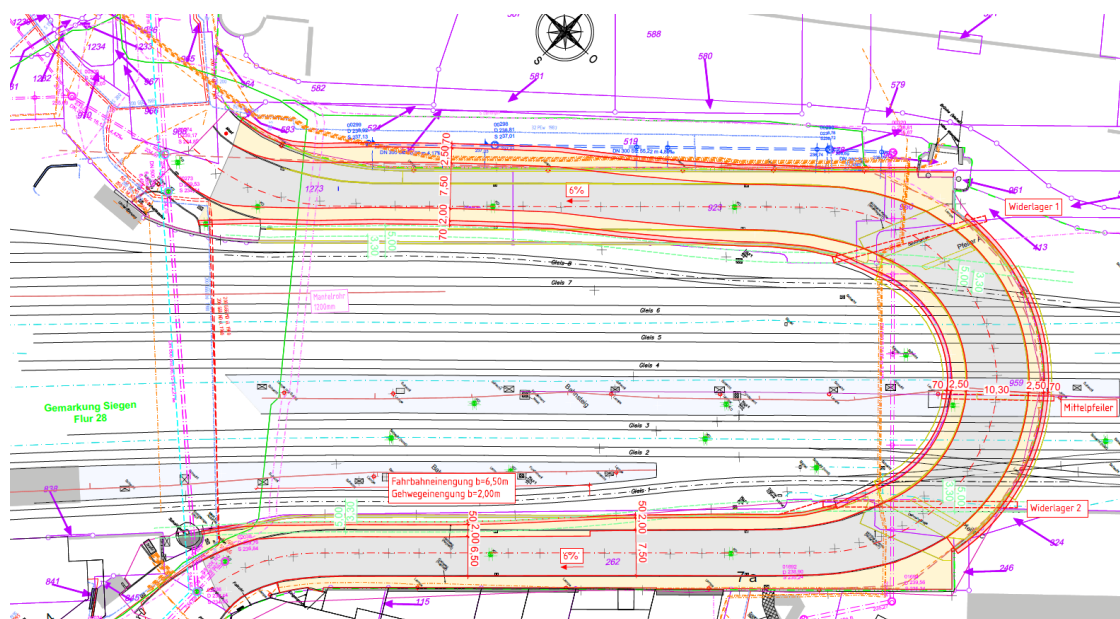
Draufsicht Straßenbrücke Stahlfachwerk im Bogen
